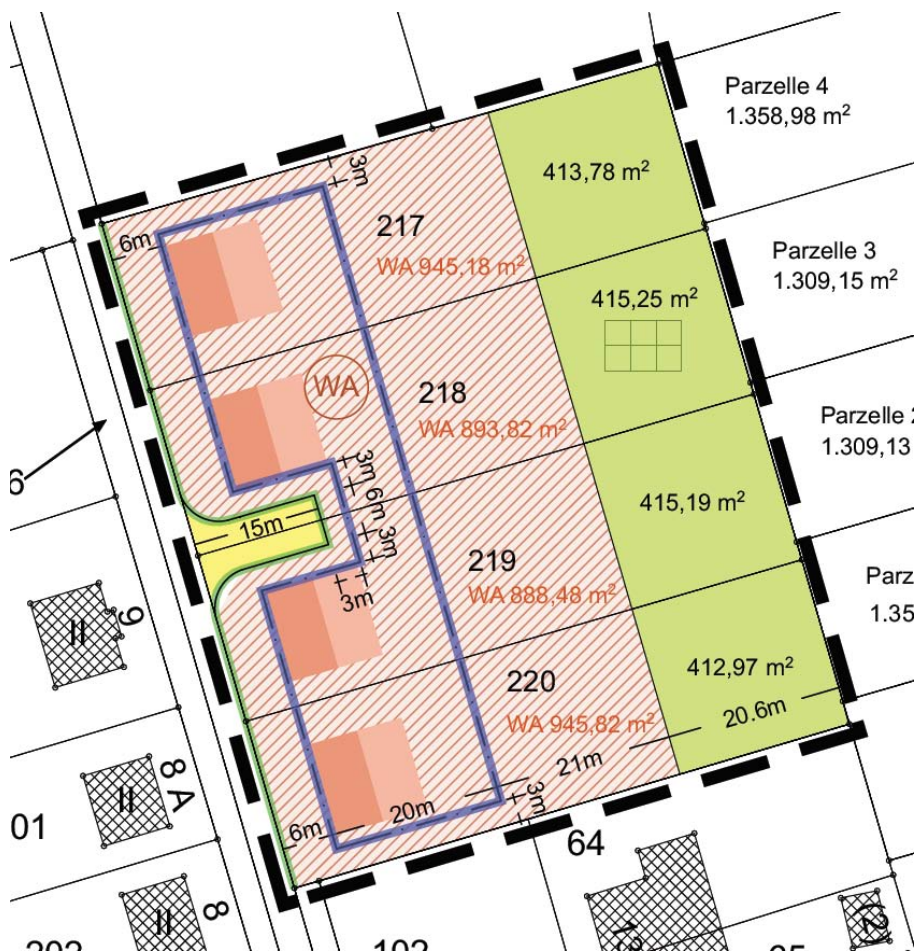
Vorentwurf Bebauungsplan „Wohnbebauung in der Mühlenstraße“ (CUBUS BAUPLANUNG UND BAUBETREUUNG IM HOCHBAU GMBH STAND JUNI 2016)
